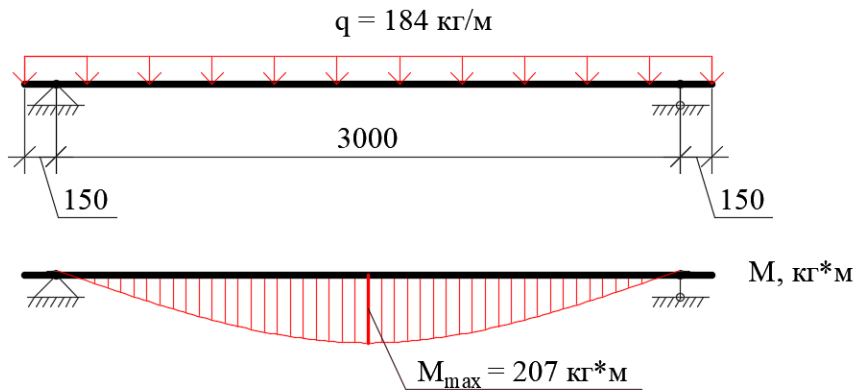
Расчетная схема балки перекрытия.
